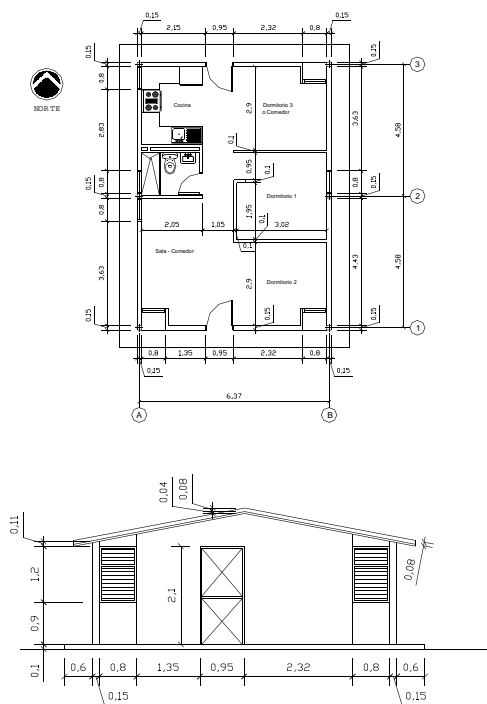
Planta y fachada sur (principal) de la vivienda original.
